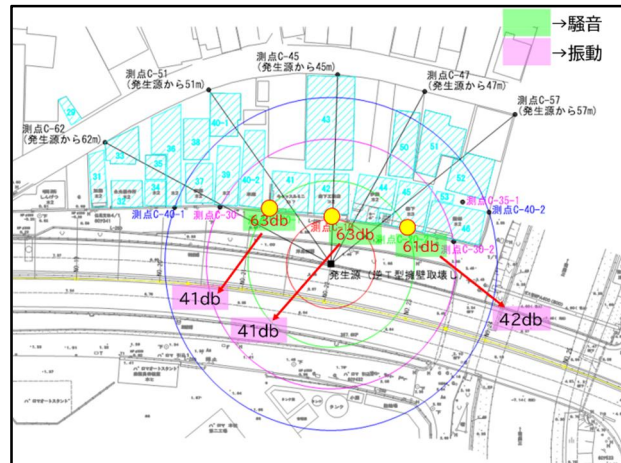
ワイヤーソーの試験施工時騒音・振動発生状況
